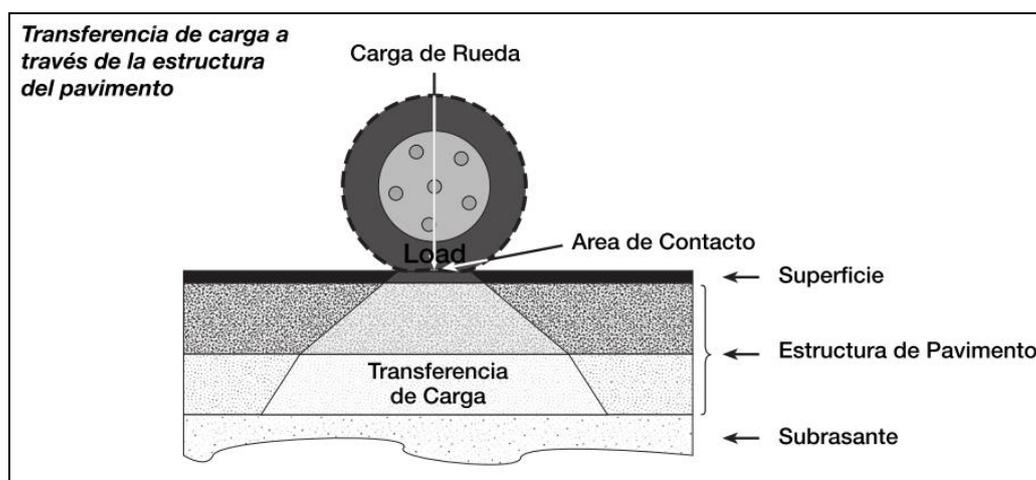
Transferencia de carga a través de la estructura del pavimento.
